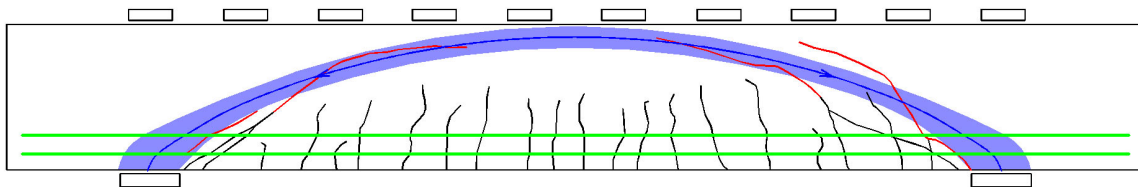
Balken BO 5 mit überlagerter Druckparabel und zugehörigen Rissen
